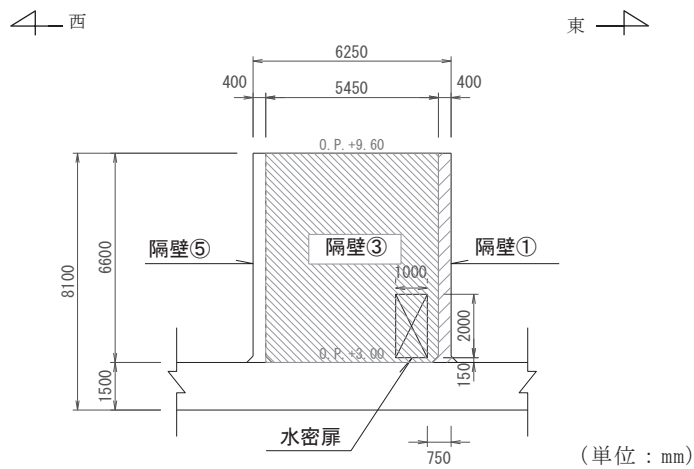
(3) 補機ポンプエリア断面図 (③—③断面)
